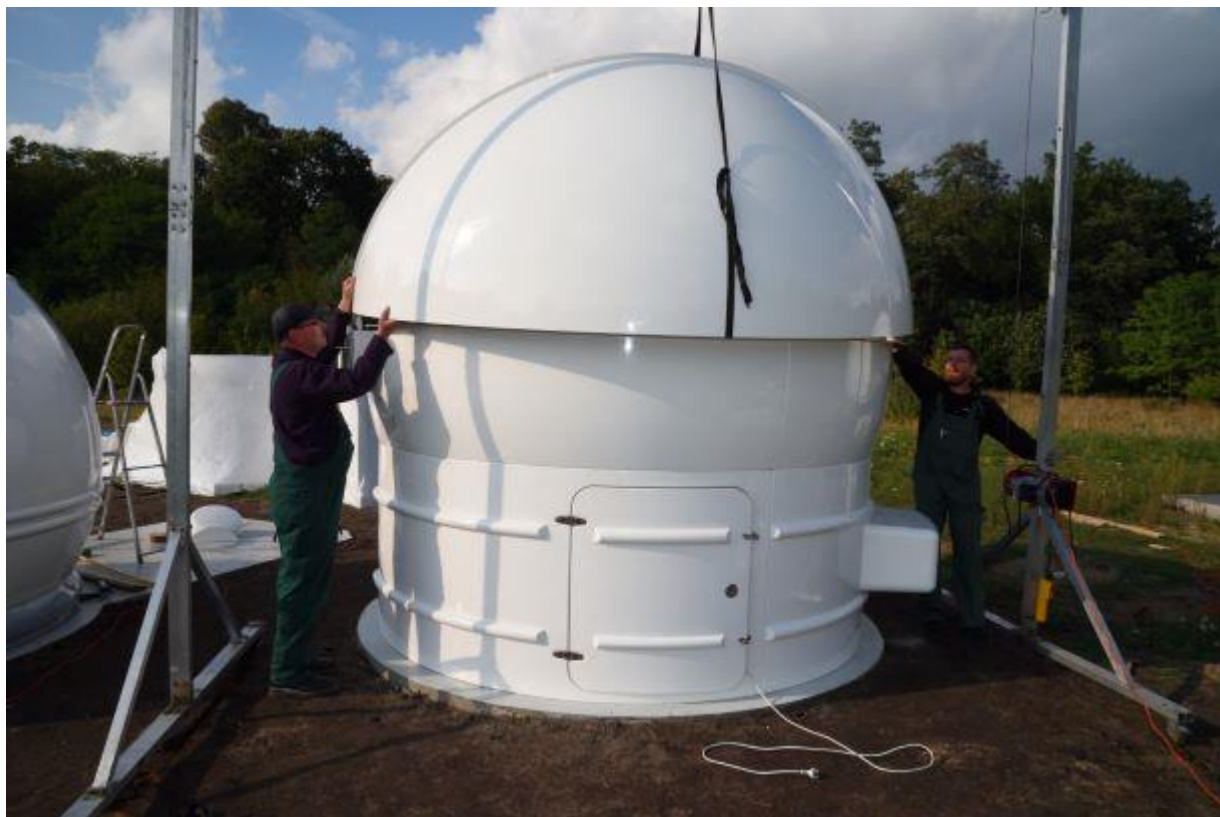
pokrywa nr 1 – orientacja przed jej montażem
